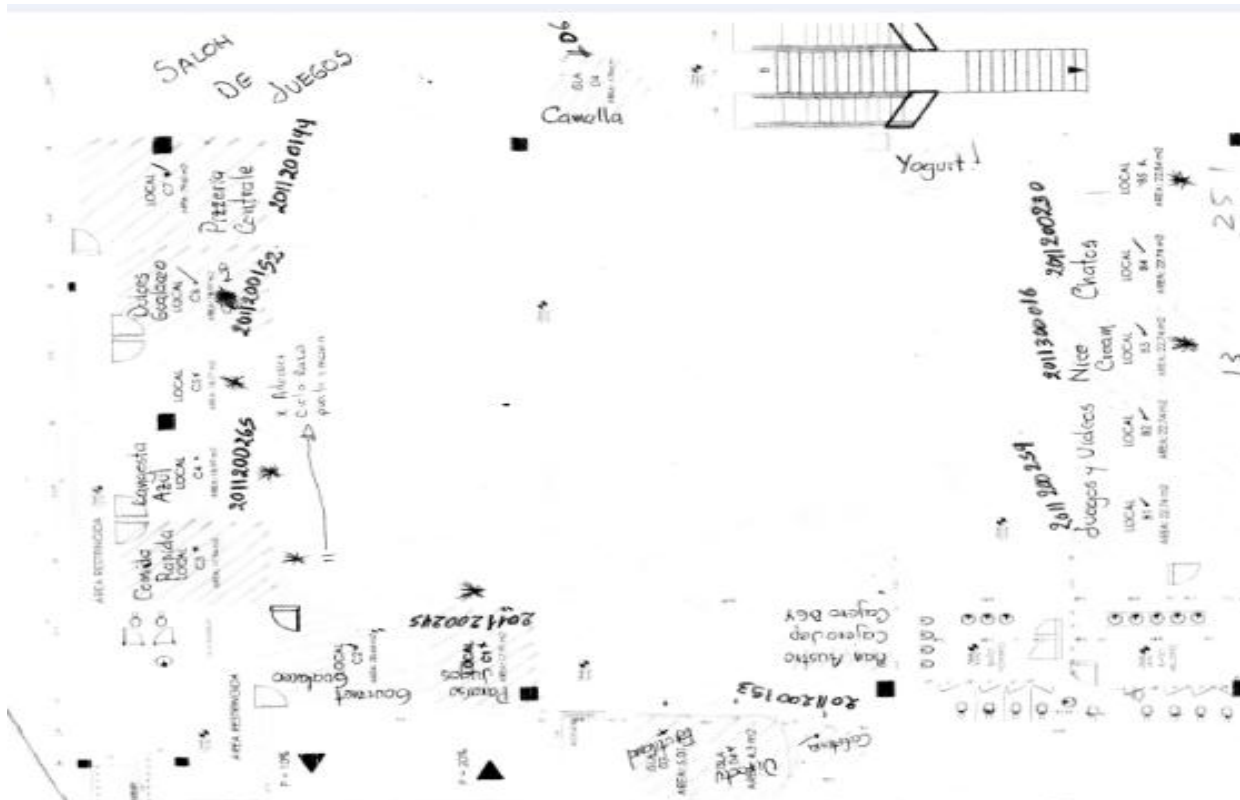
, Plano de la primera planta de MASGUAL S.A.
